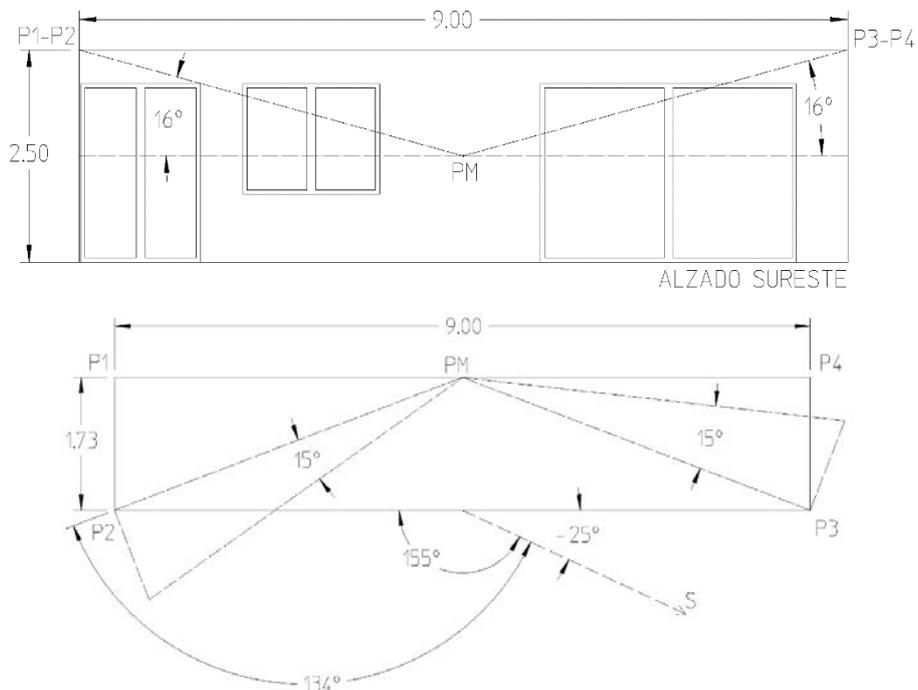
Factor de sombra en fachada sureste V2 y V4
